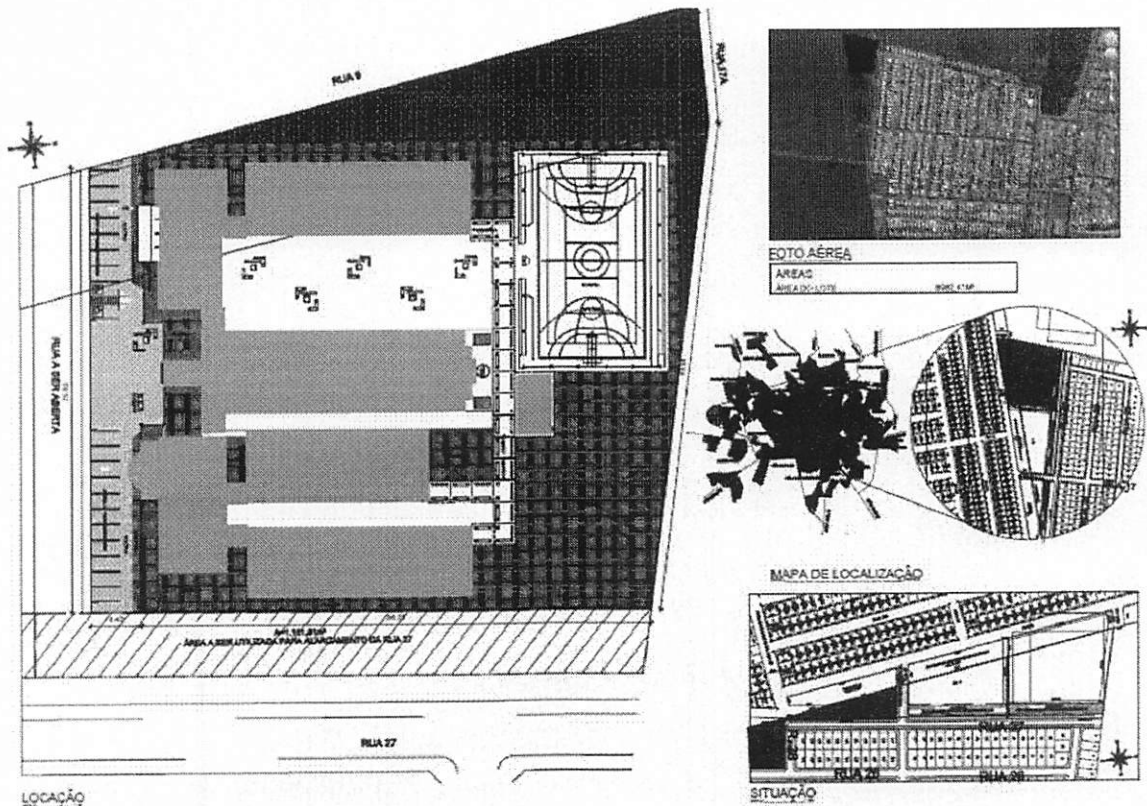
Planta de locação da obra no terreno. Exemplo Escola
